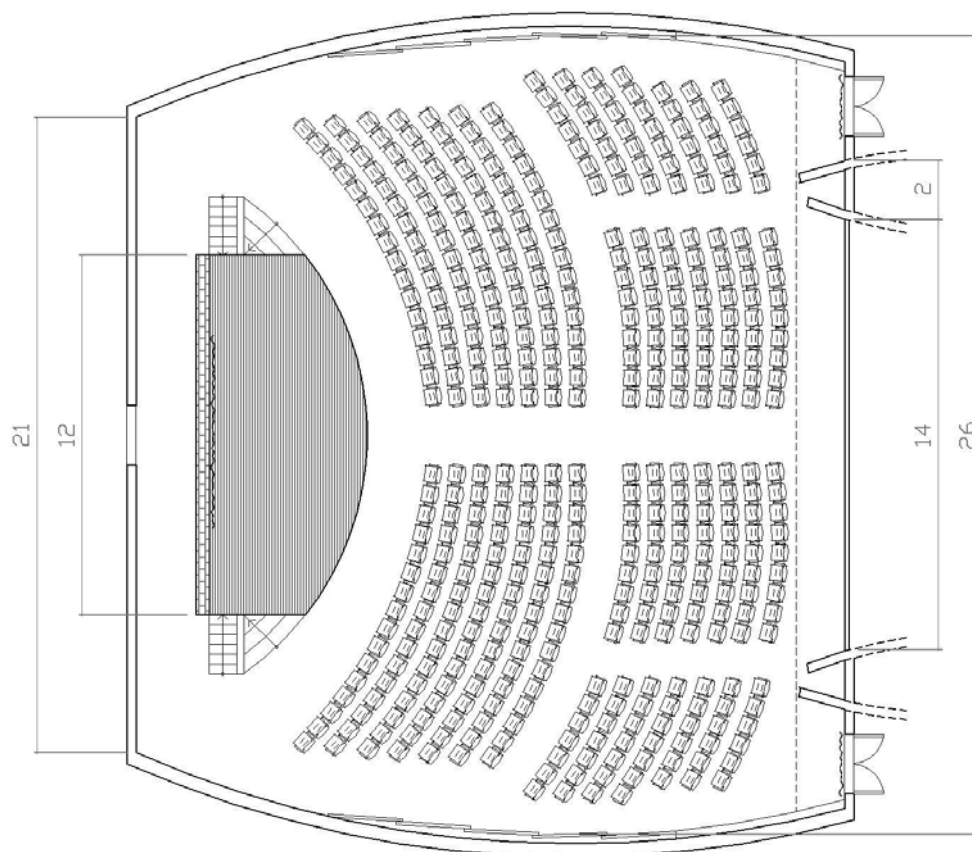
Planta con detalles constructivos del auditorio del templo de la Comunidad Amijai.
